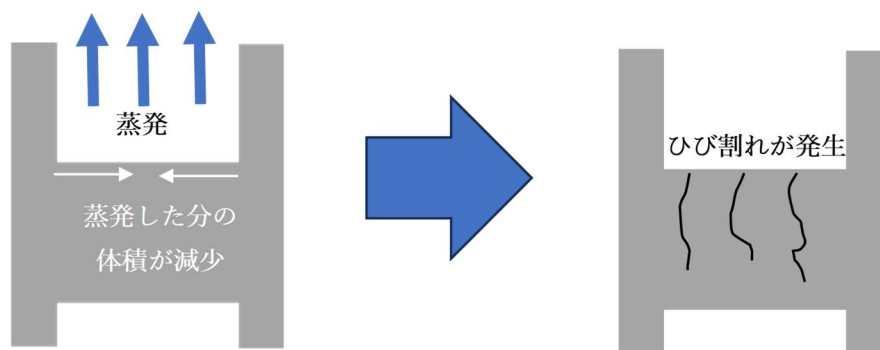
乾燥収縮によるひび割れのメカニズム
